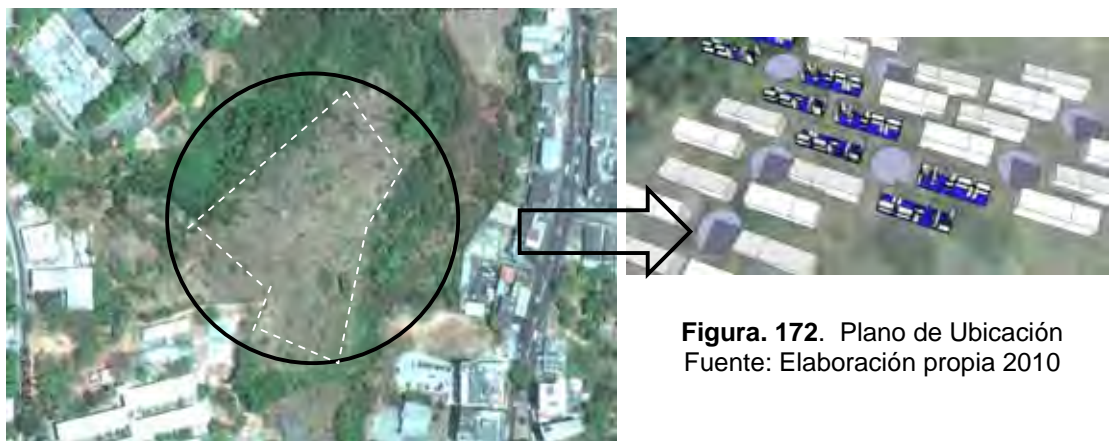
Plano de Ubicación Fuente: Elaboración propia 2010
